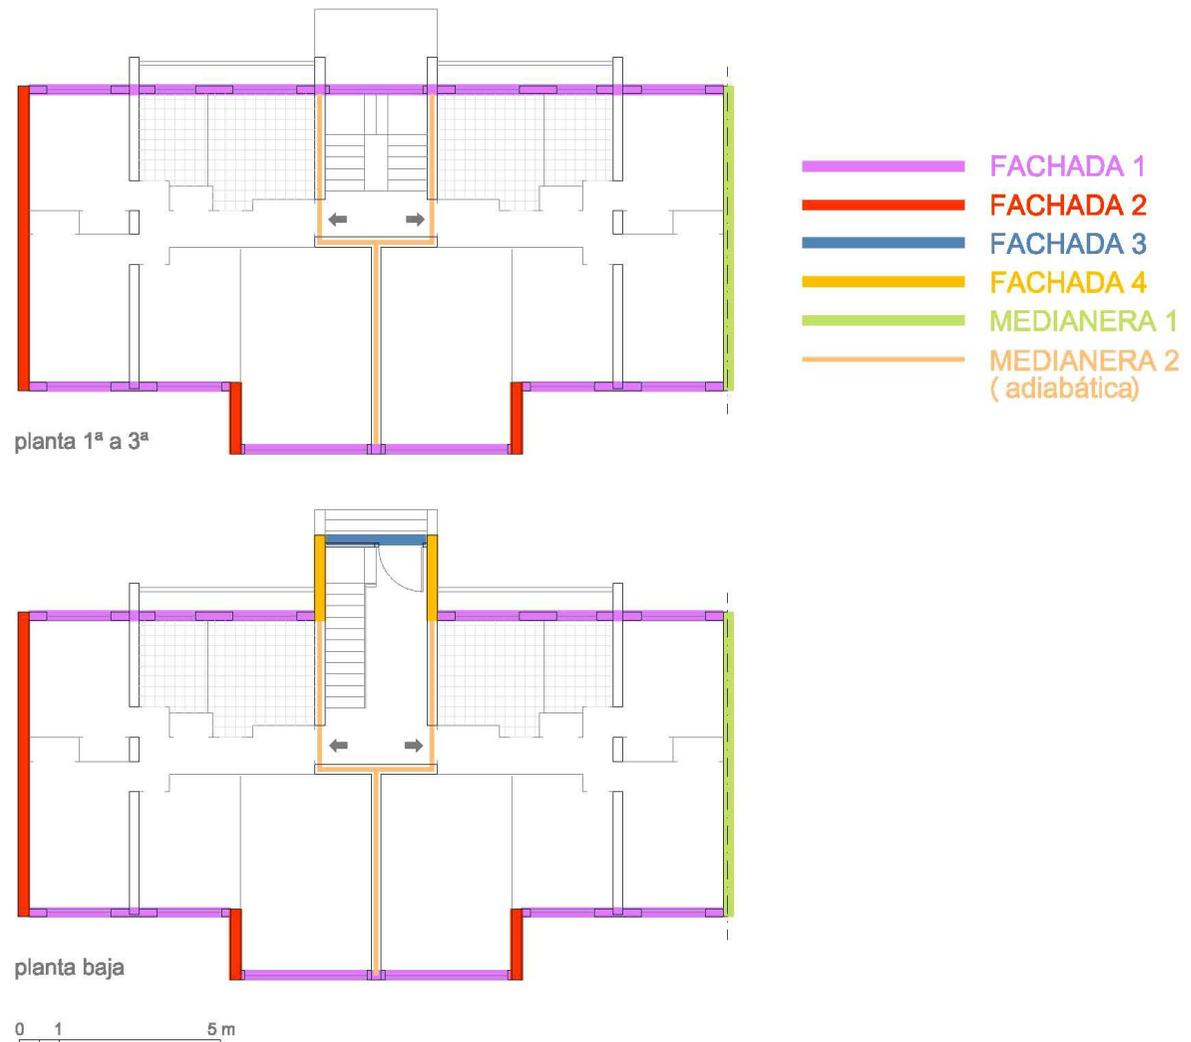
Planos de planta con caracterización de los tipos de fachadas.
